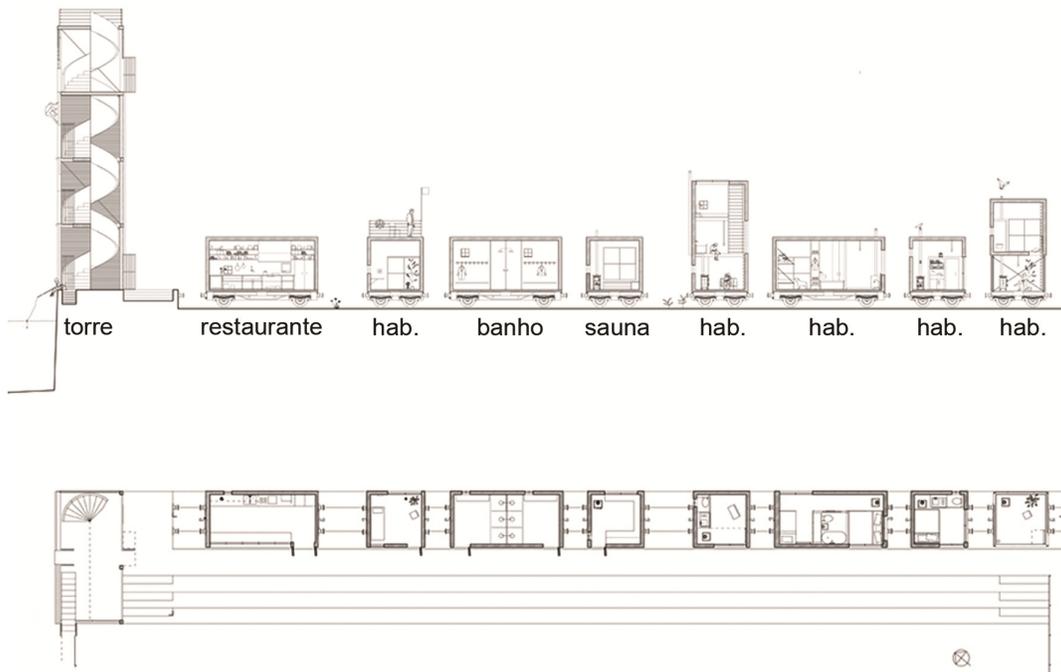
Corte e planta do hotel rolante.( En.51arch, 2012)
